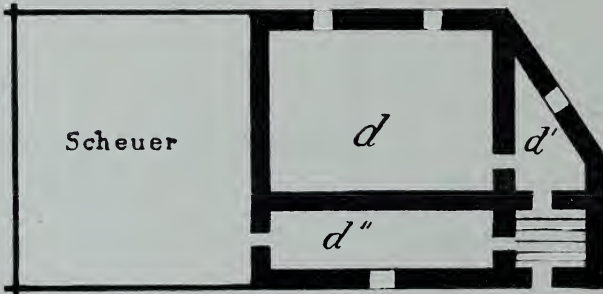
b. Erdgeschoss, darunter Keller und Stall.
